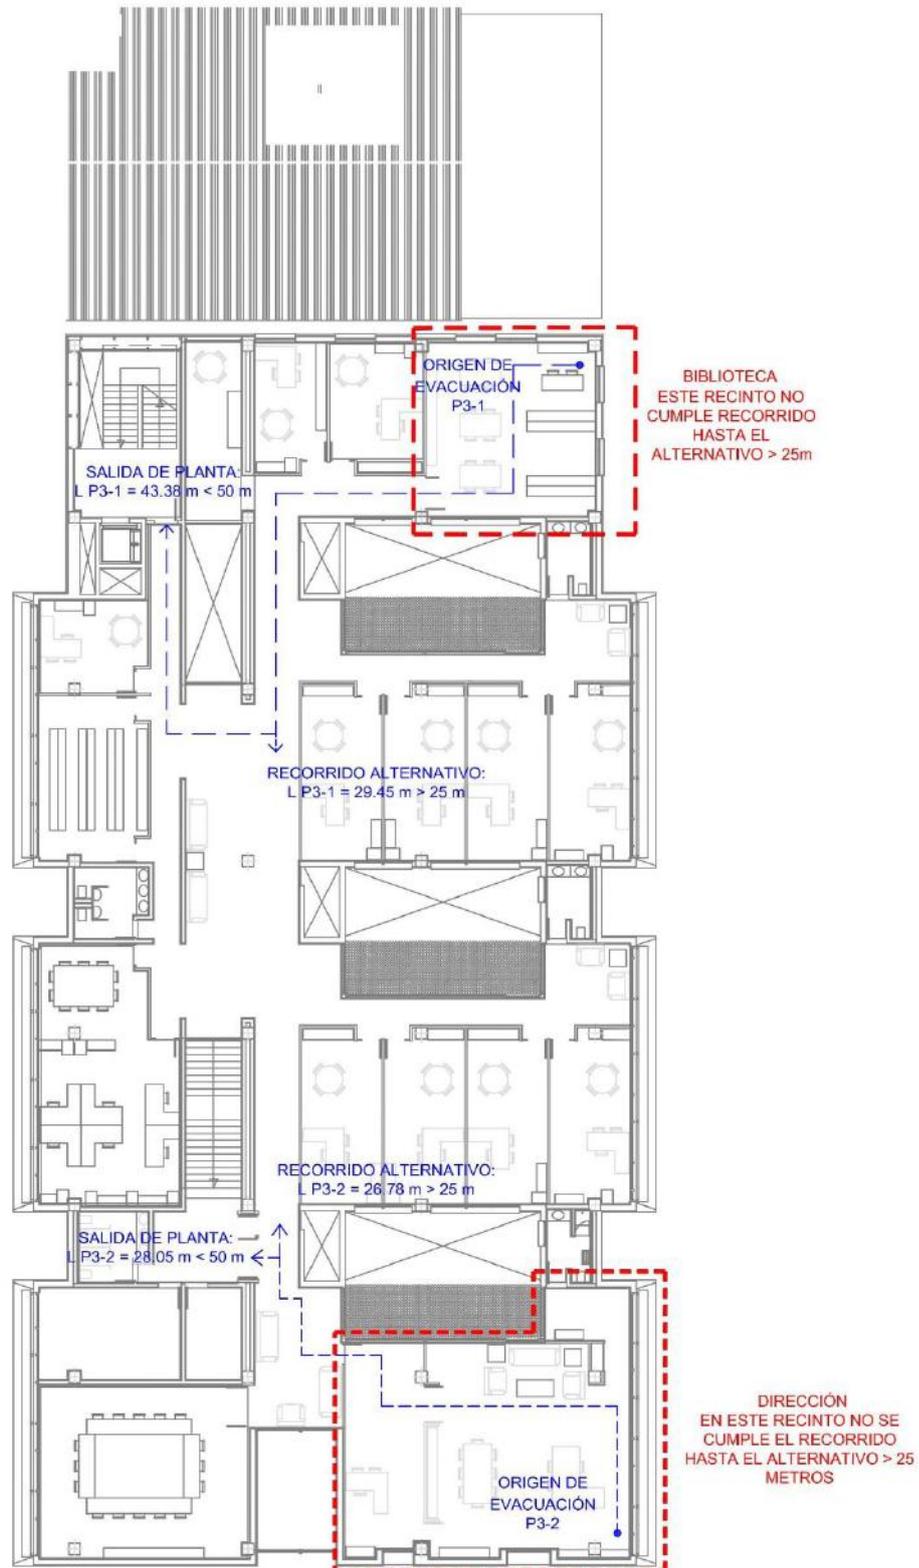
Cumplimiento Longitud Recorridos de Evacuación Planta Tercera. Figura extraída del plano 43.
